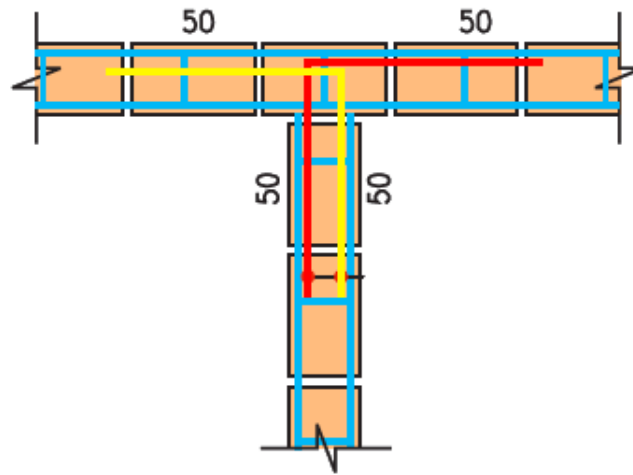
Detalle del suple en los extremos de las barras de refuerzo horizontal. Encuentro de muros en T (ACMA, 2011)
